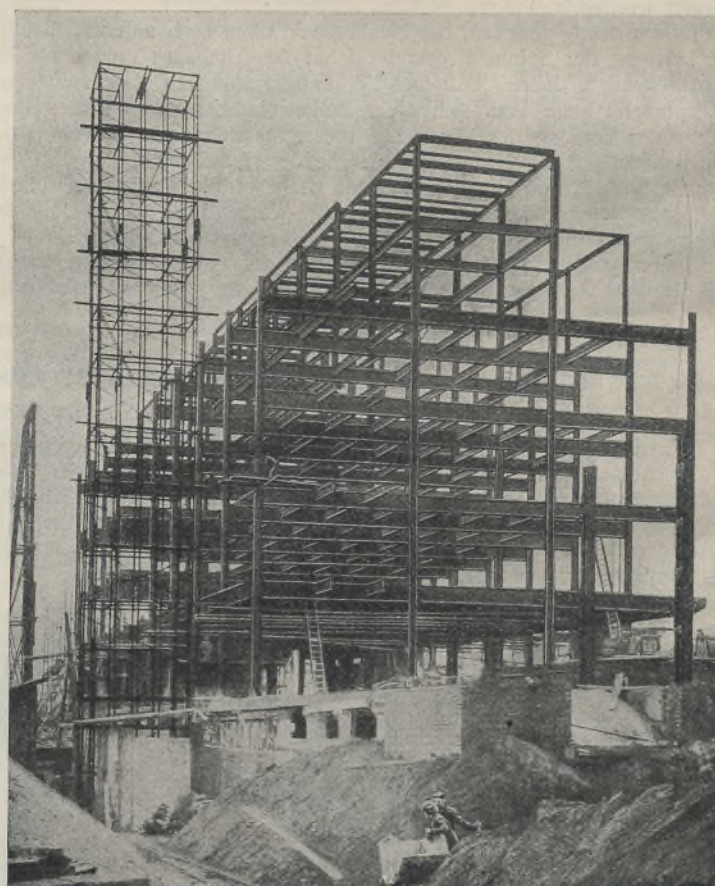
Ansicht des im Zusammenbau befindlichen Stahltragwerkes von der Schmalseite.
